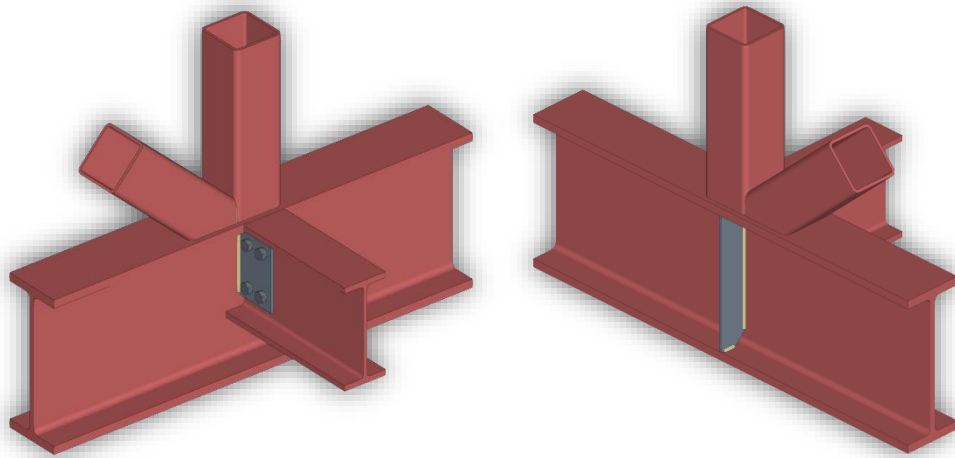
Unión viga longitudinal, viga transversal y viga reticulada
